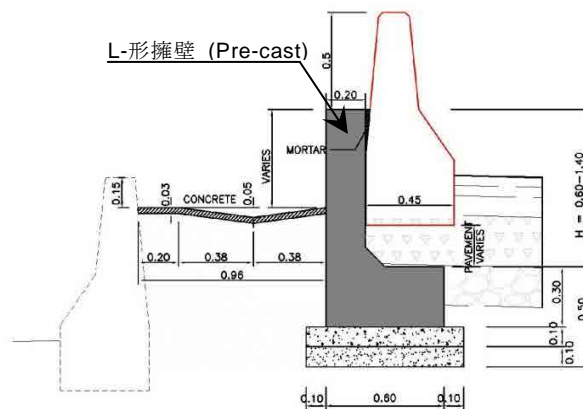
コンクリートバリアとL形擁壁構造
